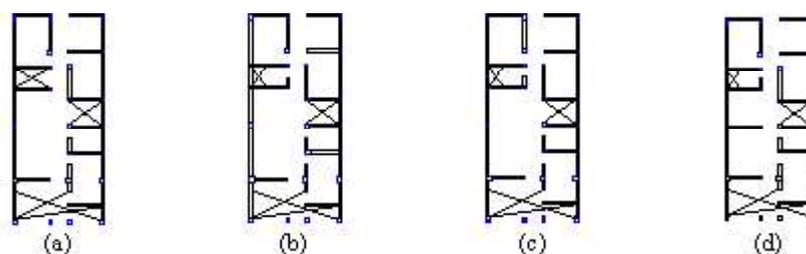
Vista en planta de viviendas típicas en albañilería confinada e informal para densidades de muros (a)1.5%,(b)2%,(c),2.5% y (d)3%
